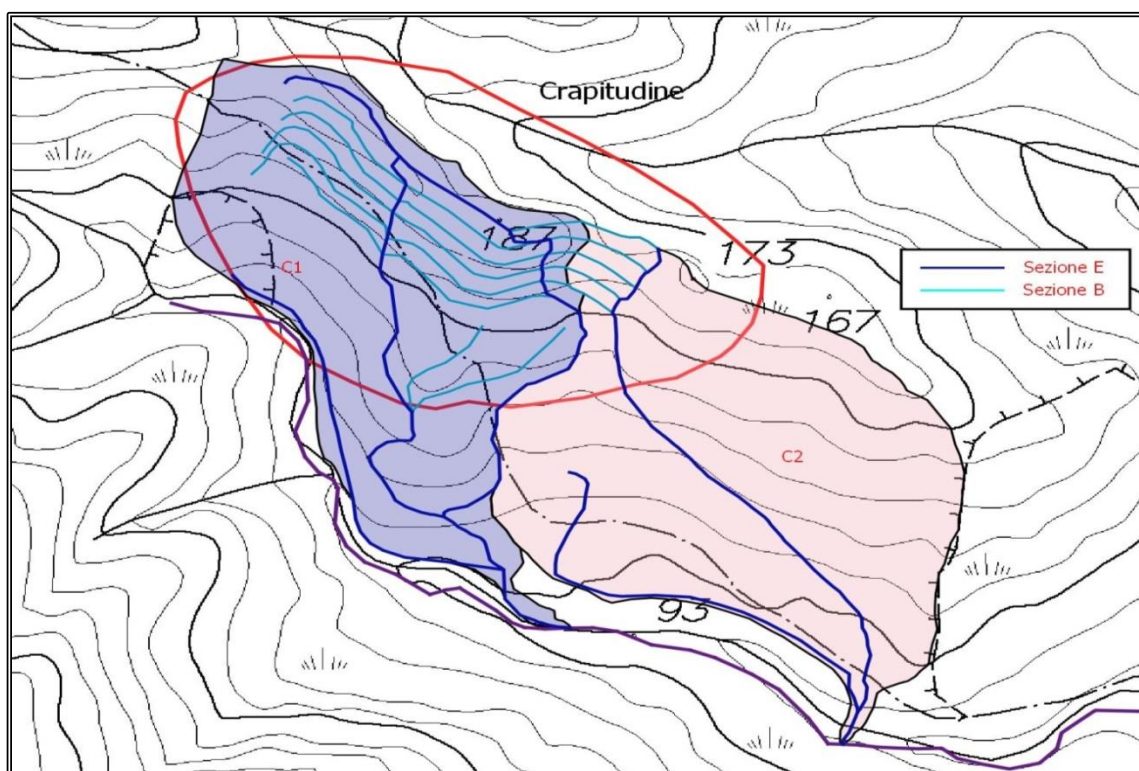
Schema della rete di drenaggio, con tipologia di sezione trasversale di progetto (Cantiere di Crapitudine C1-C2).
